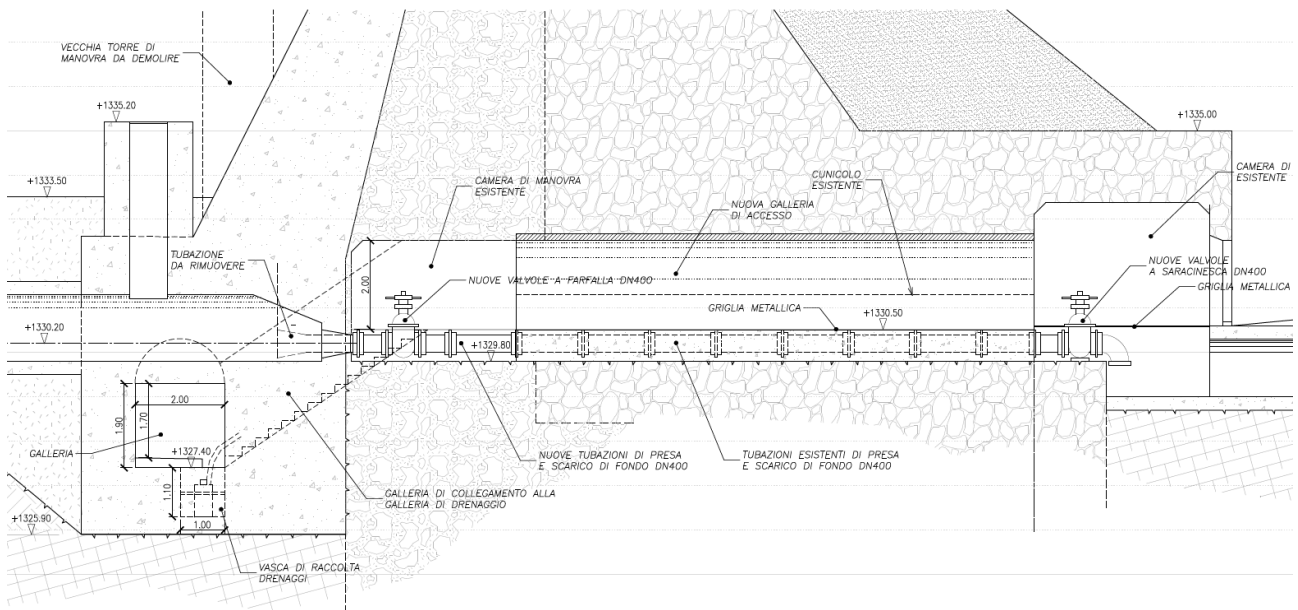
Sezione trasversale dello scarico di fondo e opera di presa
